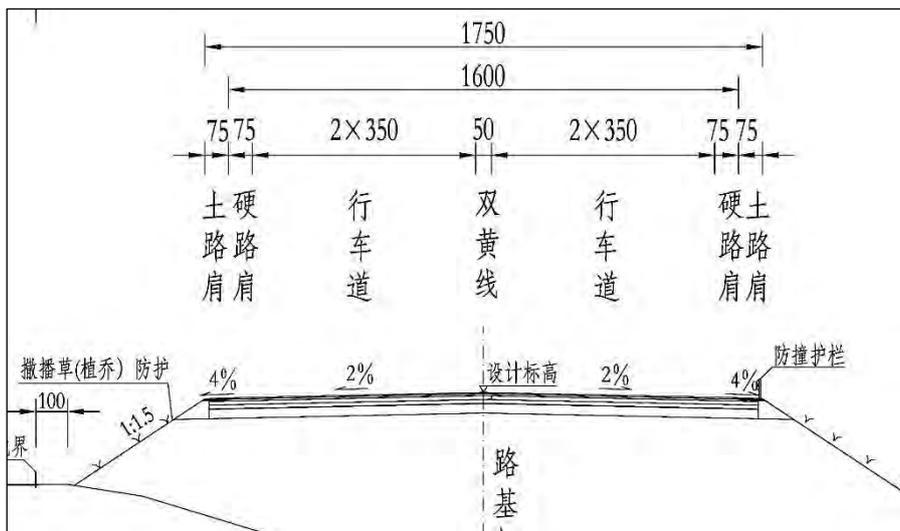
连接线路基横断面图（路基宽 17.5m）
